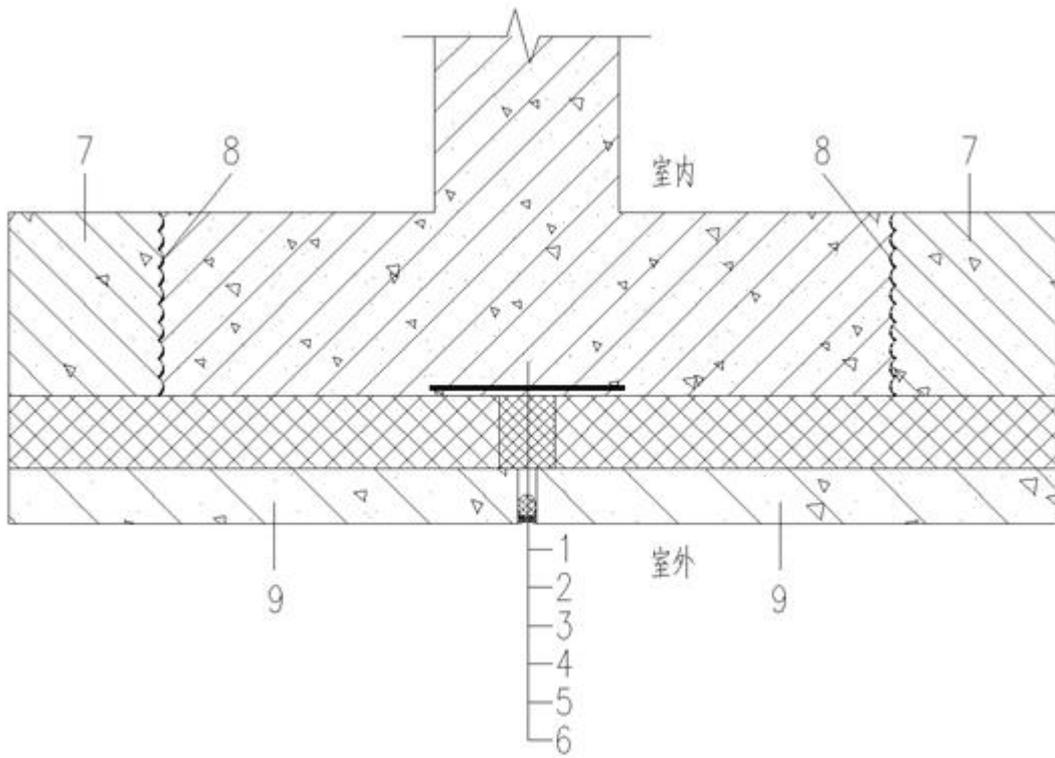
平直预制混凝土夹心保温墙板垂直缝密封防水构造
